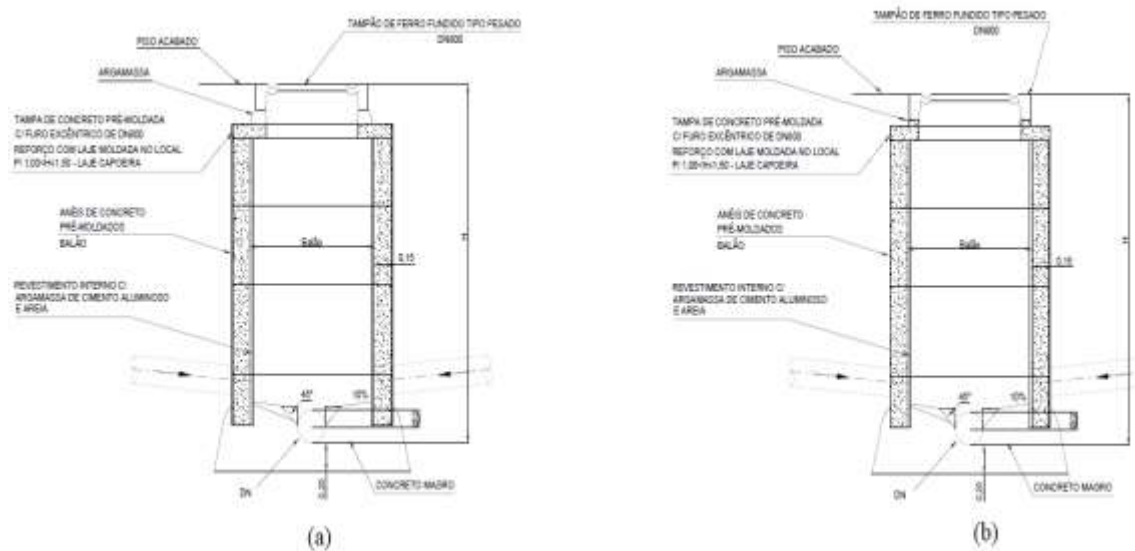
Detalhe construtivo para execução de Poço de Vista.
